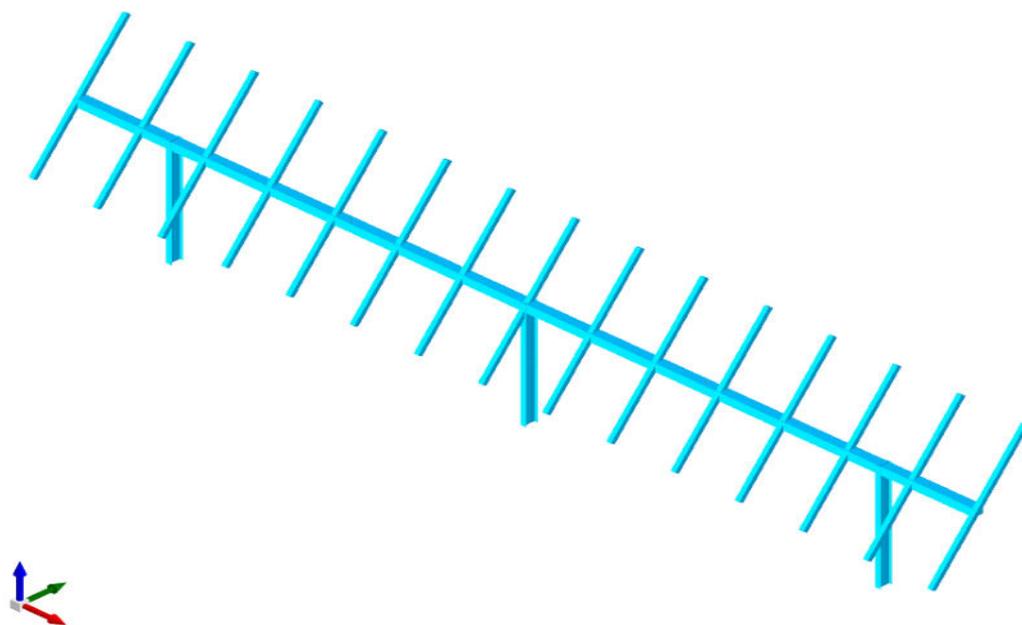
Vista assonometrica modello strutturale con posizione della “vela” inclinata di 55°
